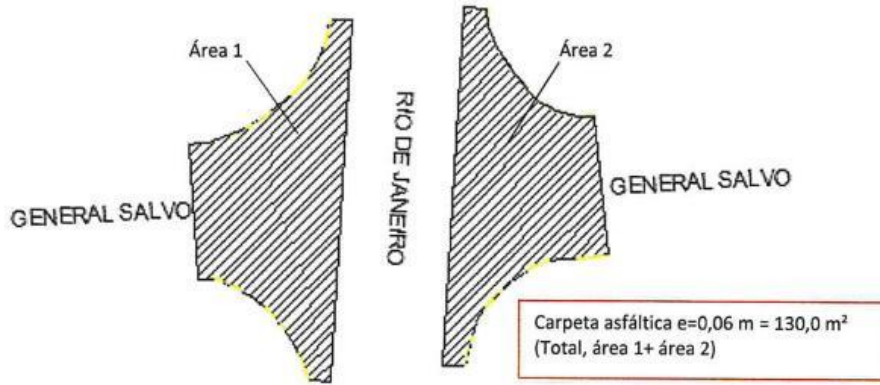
Reposición de calzada asfáltica en calle General Salvo con calle Brasilia, faja en paralelo a límites de obras por lado poniente.
